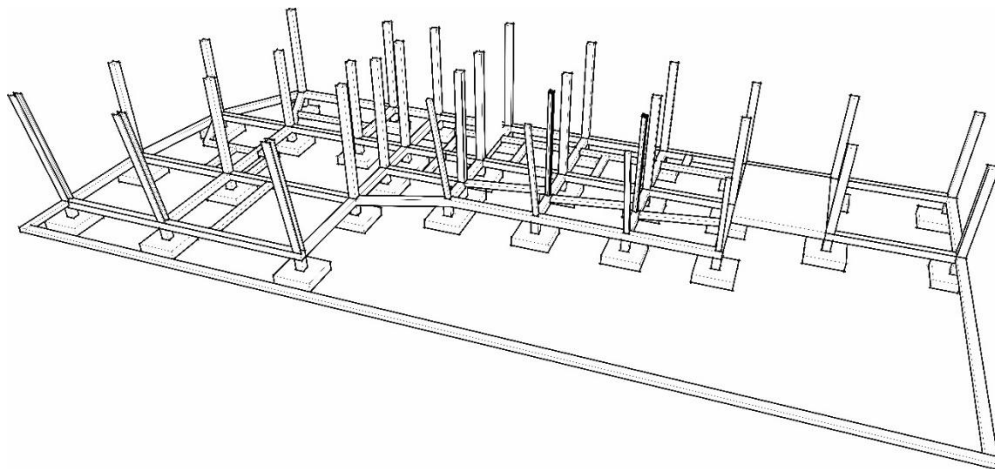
Sobrecimiento. Viga de amarre muros confinados y cerramiento.
